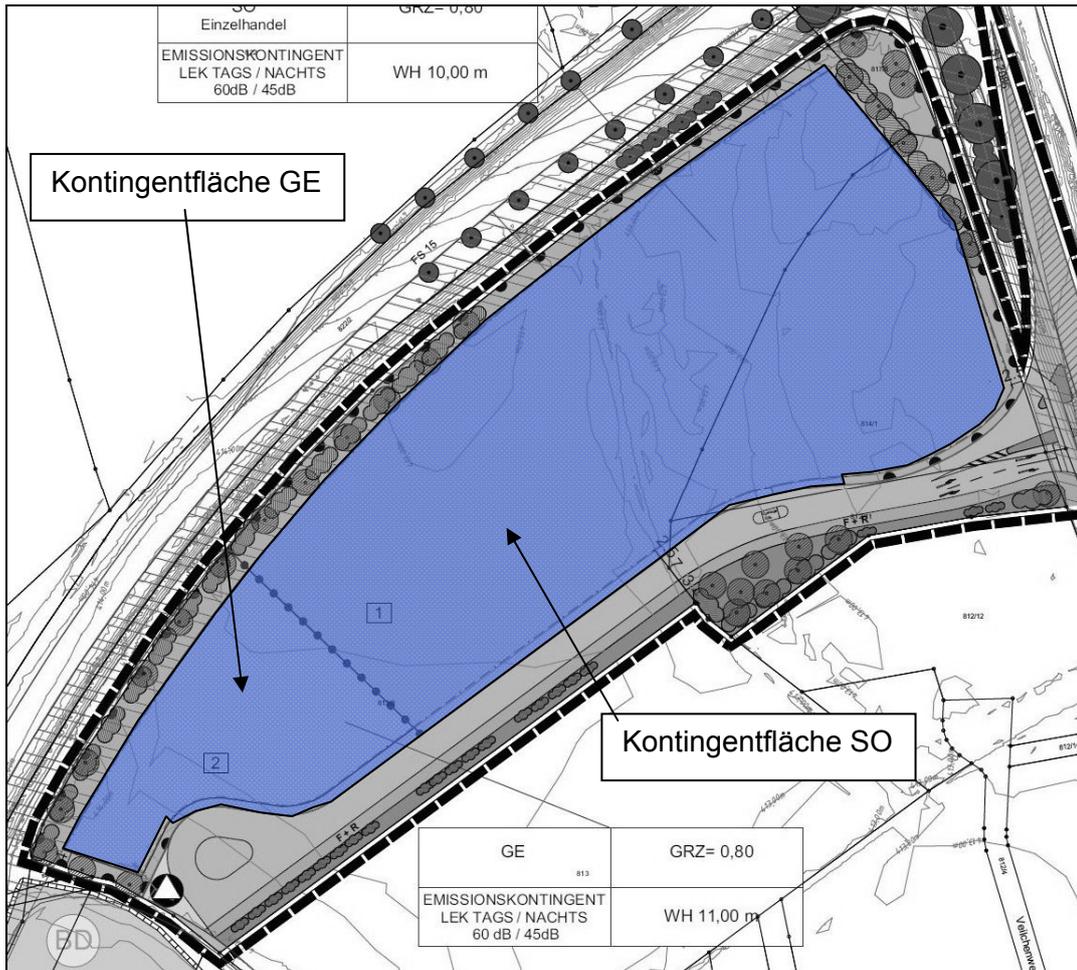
B-Plan "Sondergebiet Amperauen", Lageplan mit Kontingentflächen (blau)
